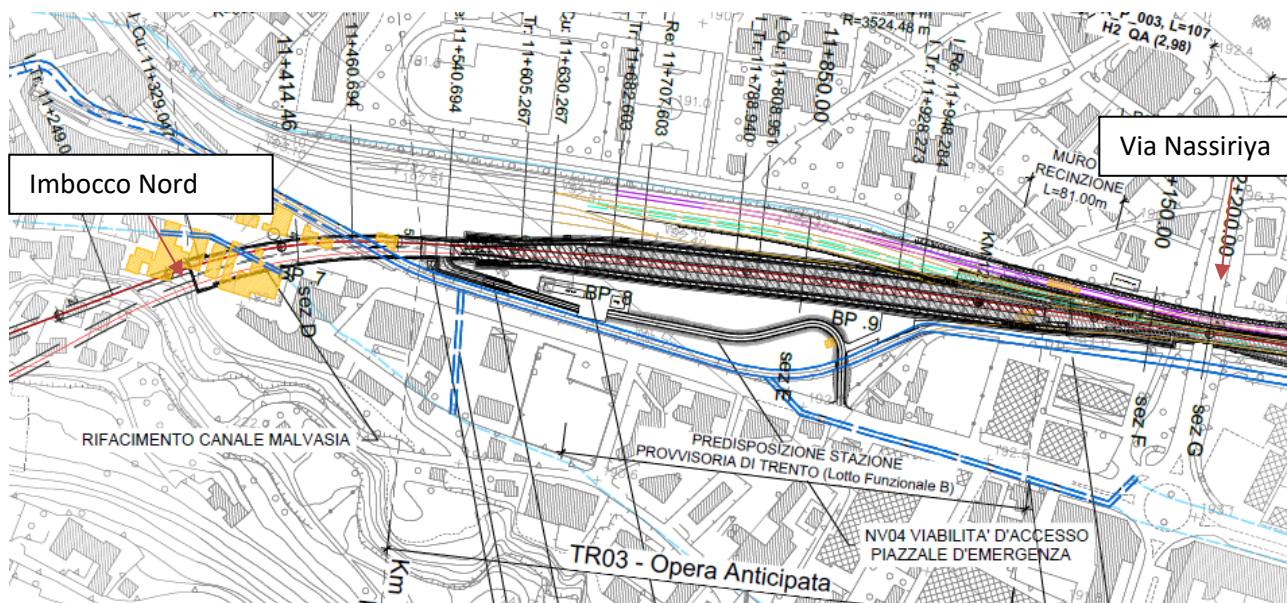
Planimetria imbocco nord – Scalo Filzi
